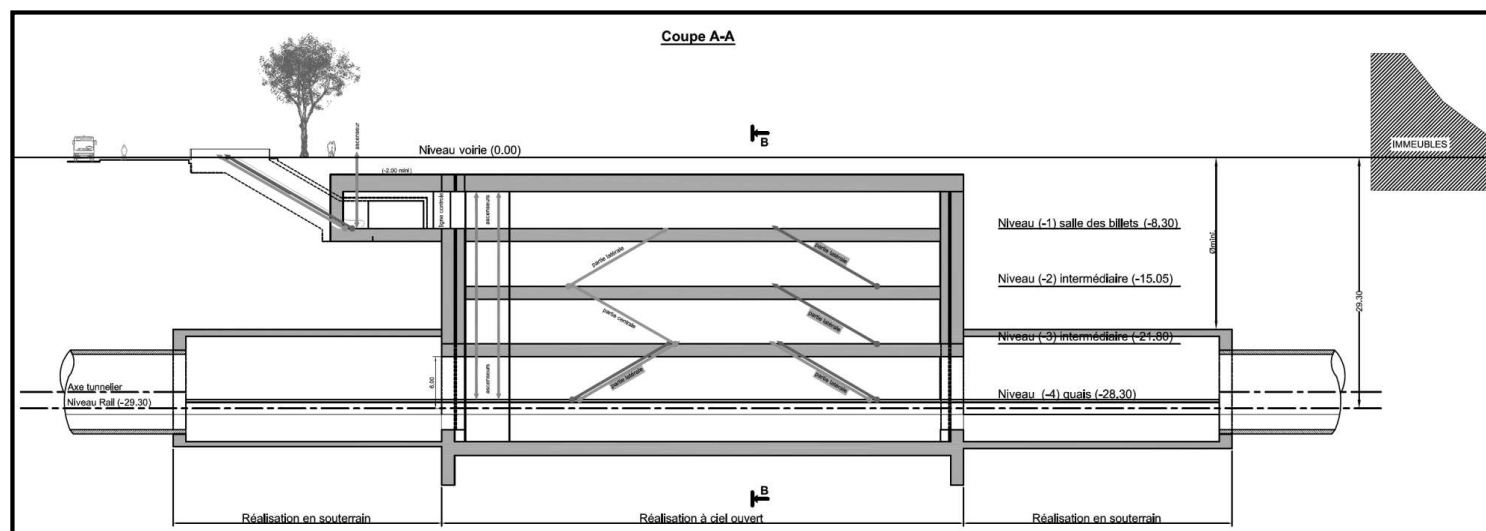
Coupe type longitudinale d'une station construite en souterrain
